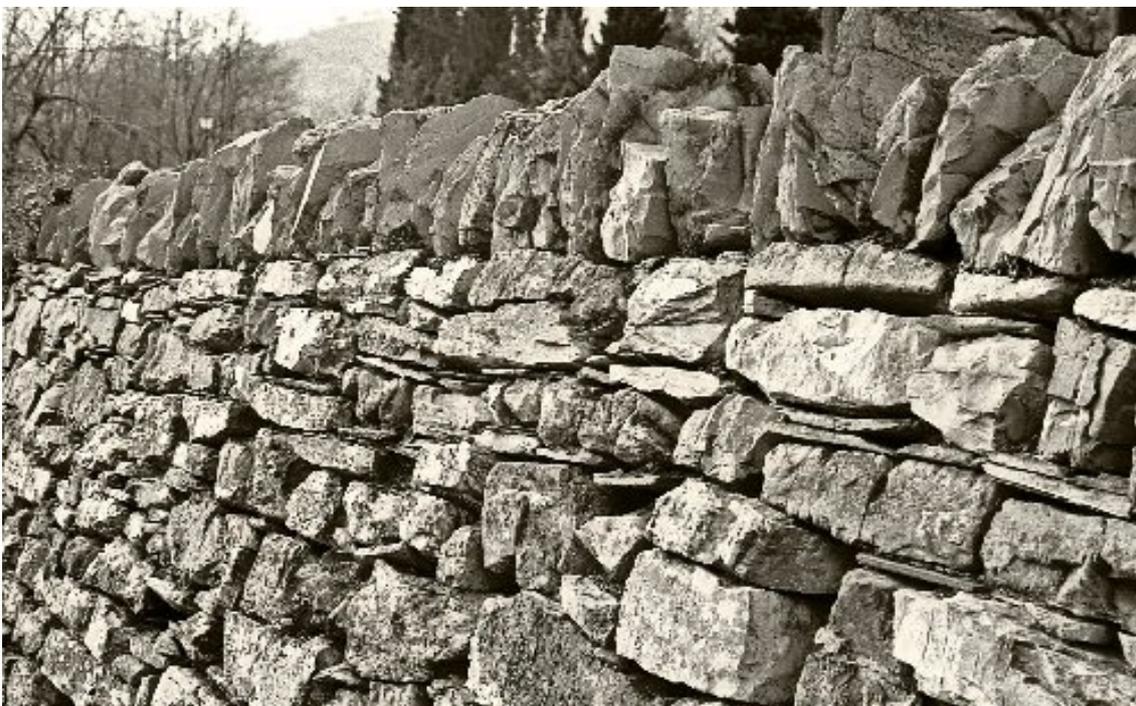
Particolare disposizione delle pietre (foto di A. Persano).
